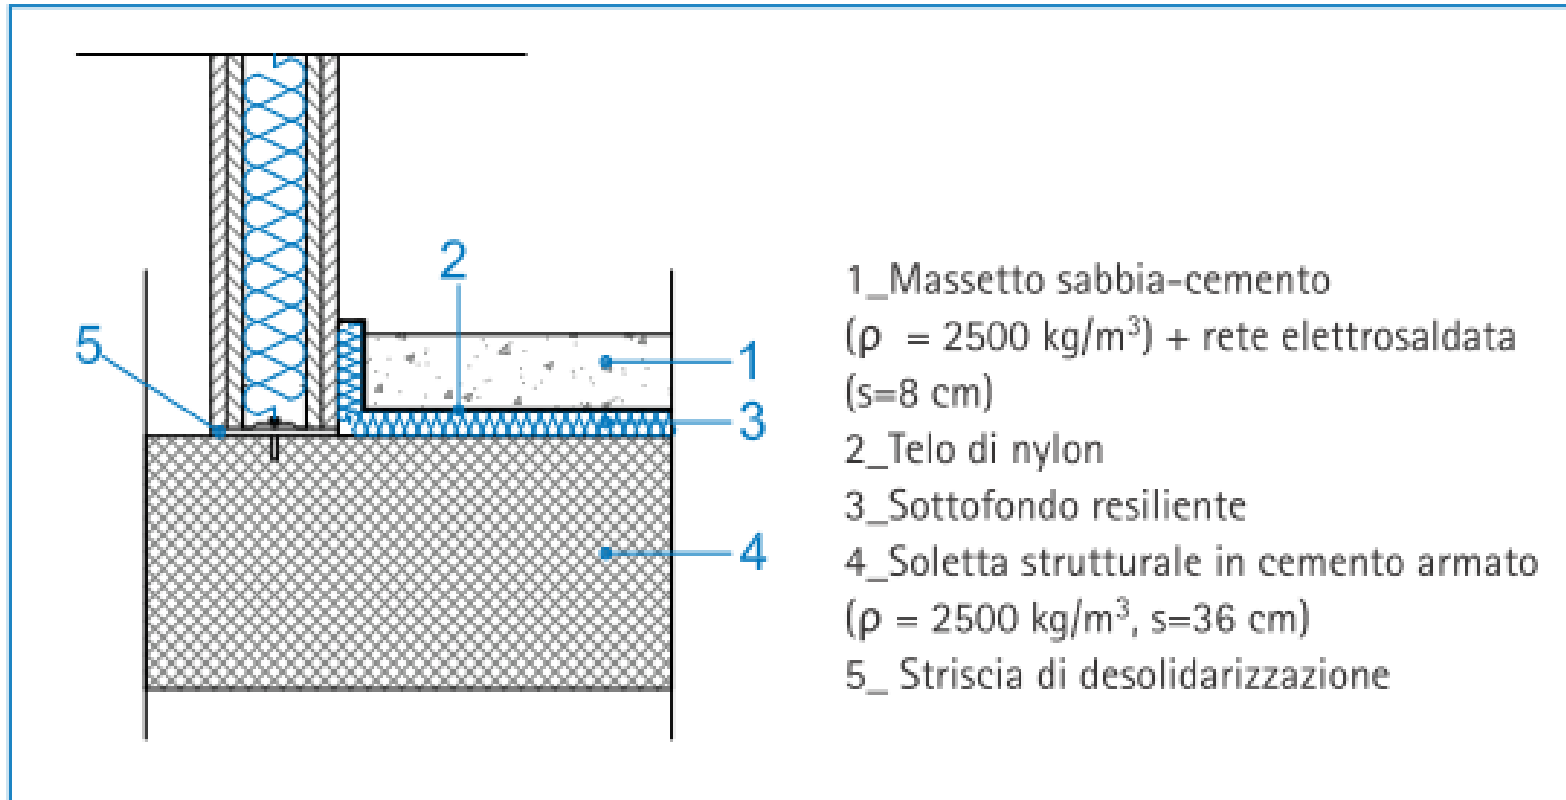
esempio di realizzazione di pavimento galleggiante su soletta in cemento armato con parete verticale leggera.
